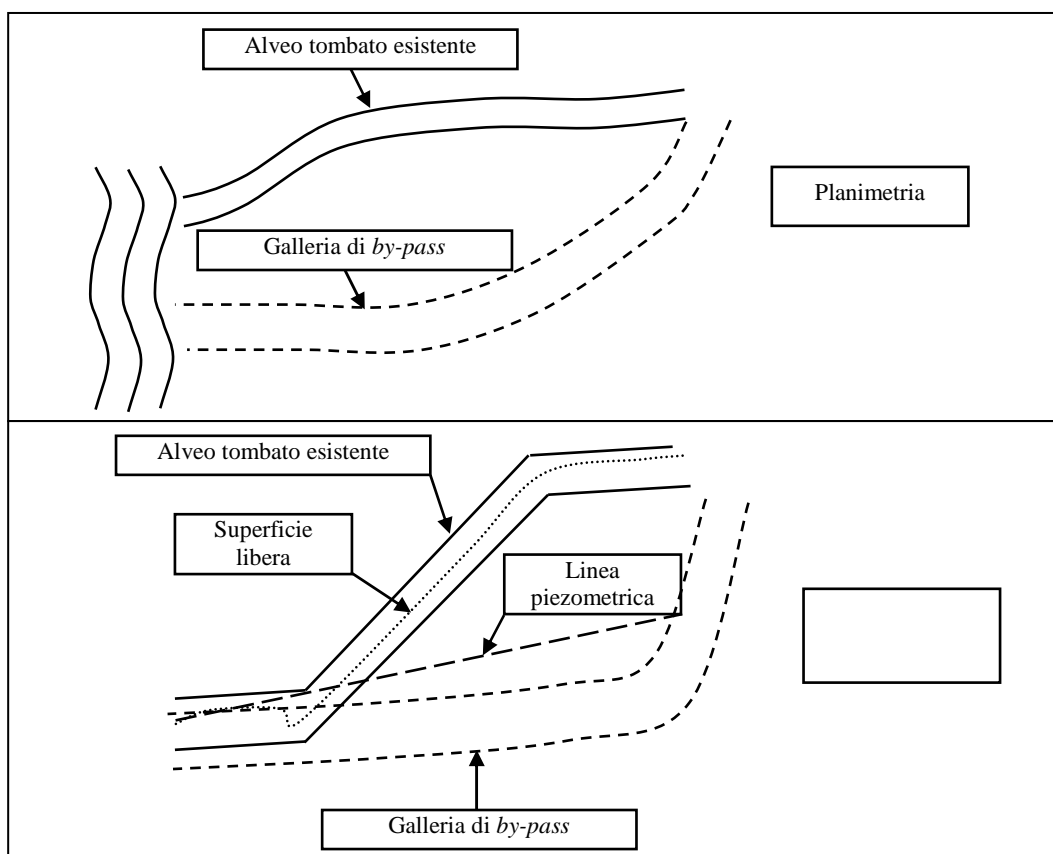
Planimetria e sezione longitudinale galleria di *by-pass
